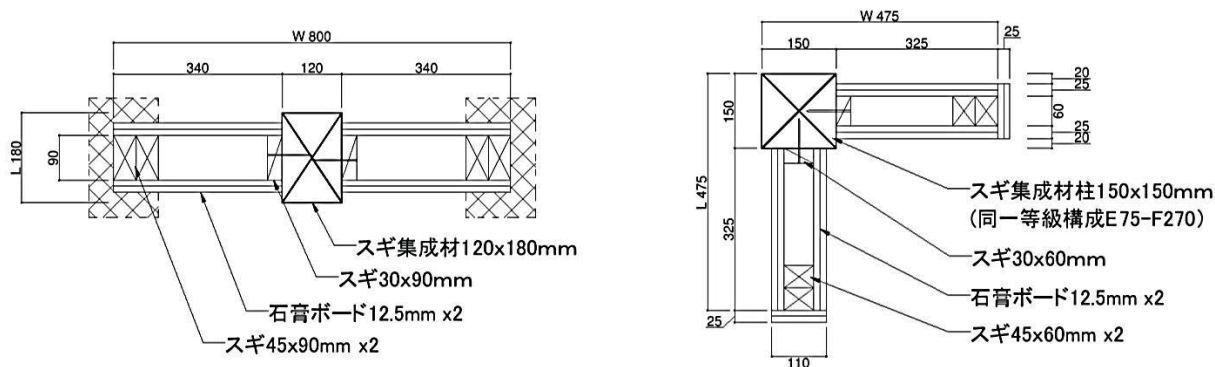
CW-1 (左)、CW-2 (右) 試験体概要図
